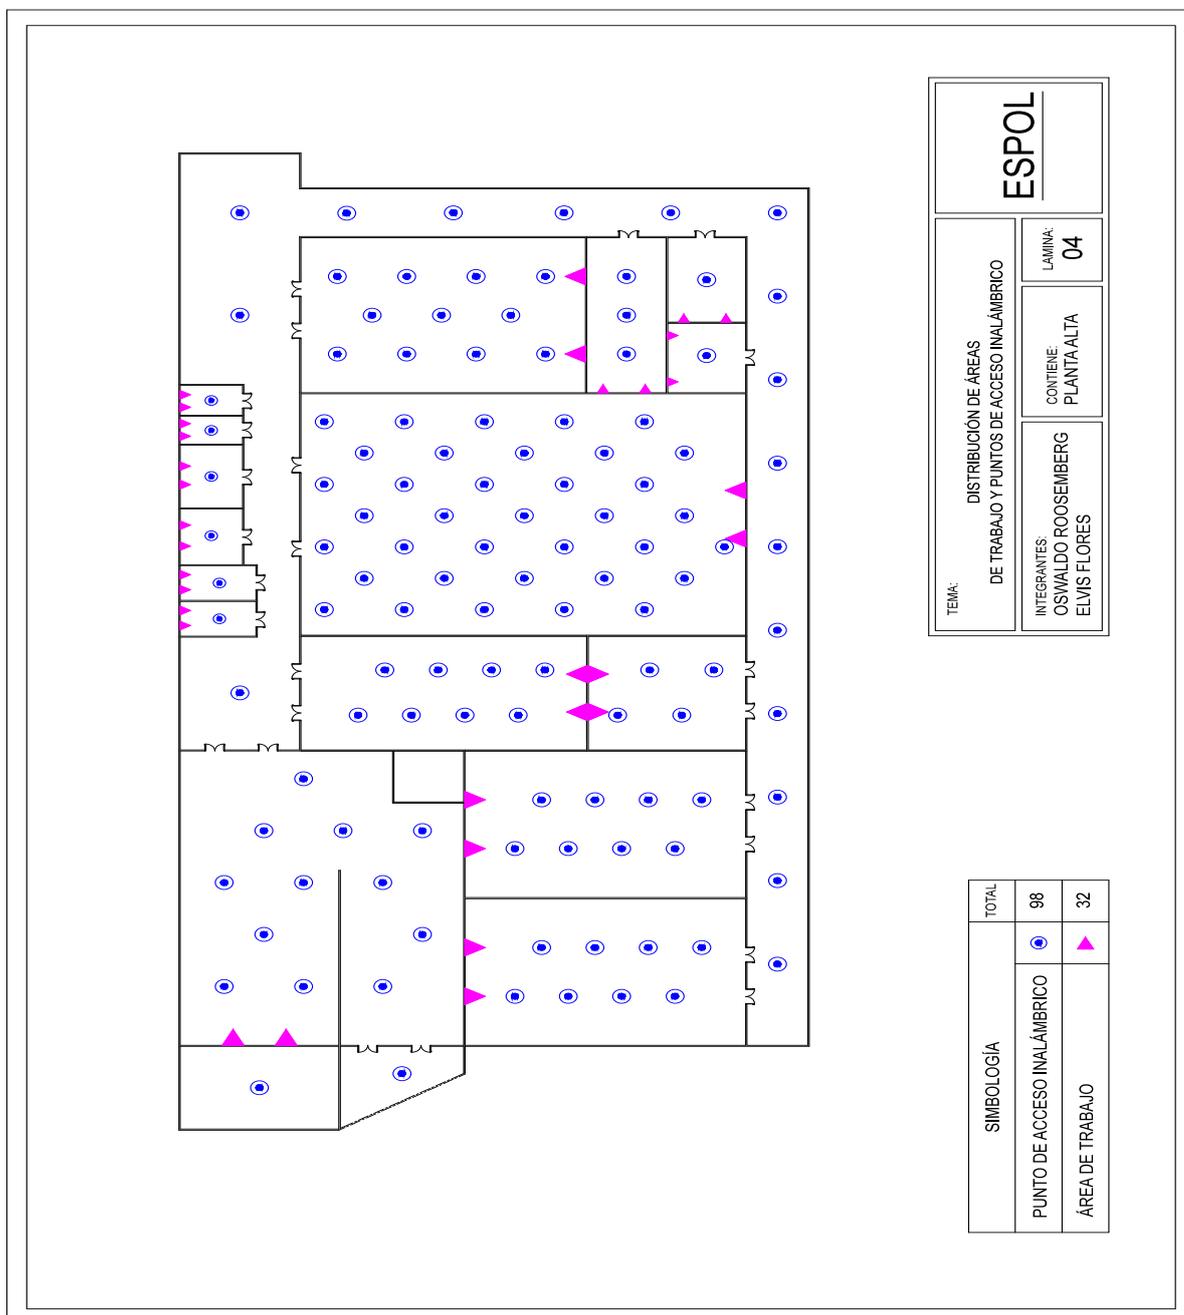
Plano de Distribución de Puntos de Consolidación, Áreas de Trabajo y Puntos de Acceso Inalámbrico – Planta Alta.
